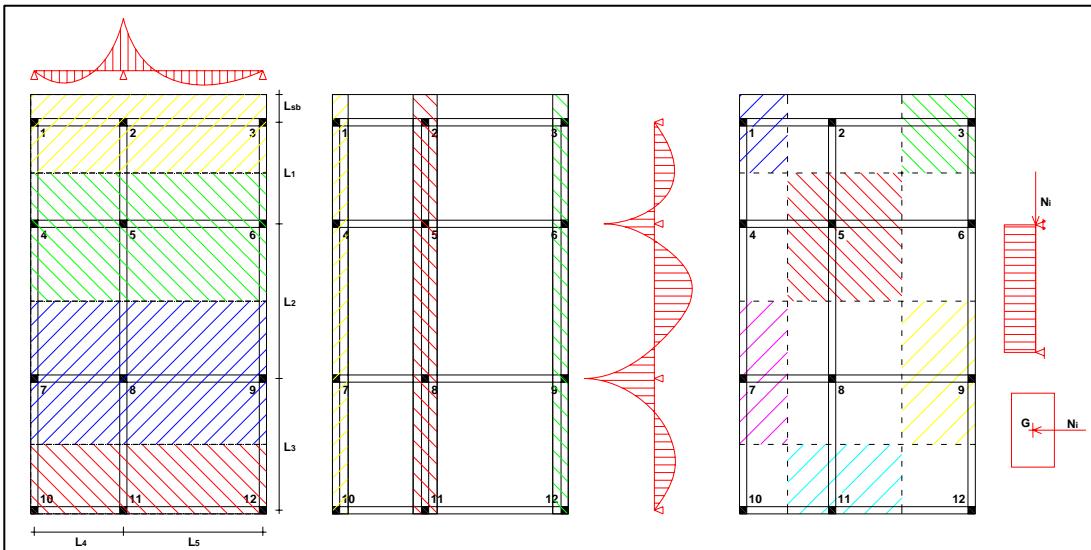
Modelli di calcolo per il predimensionamento degli elementi strutturali, rispettivamente da sinistra: (1) travi trasversali; (2) travi longitudinali; (3) colonne.
